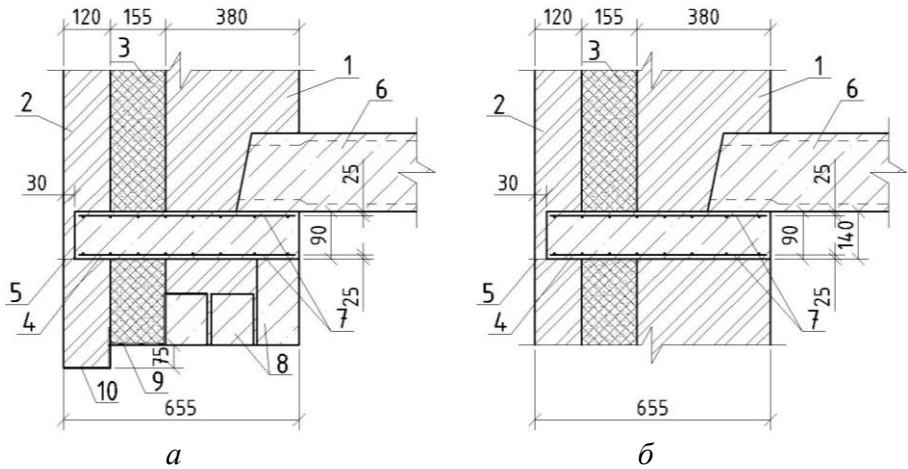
Конструкція зовнішньої багатошарової стіни багатоповерхового будинку з цегляної кладки: *а* – переріз по вікну; *б* – переріз по простінку; 1 – несучий шар із цегляної кладки; 2 – лицьовий шар із лицьової керамічної цегли; 3 – утеплювач із пінополістиролу; 4 – монолітний пояс із керамзитобетону; 5 – пружна прокладка; 6 – плита перекриття; 7 – арматурні сітки; 8 – перемички; 9 – армований шар розчину; 10 – прокатний кутик 125×10
